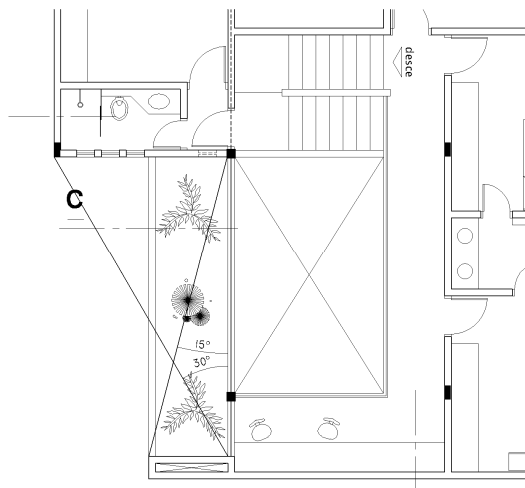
Projeto 1 - Planta – ângulo de proteção do elemento vertical na Fachada Sul
